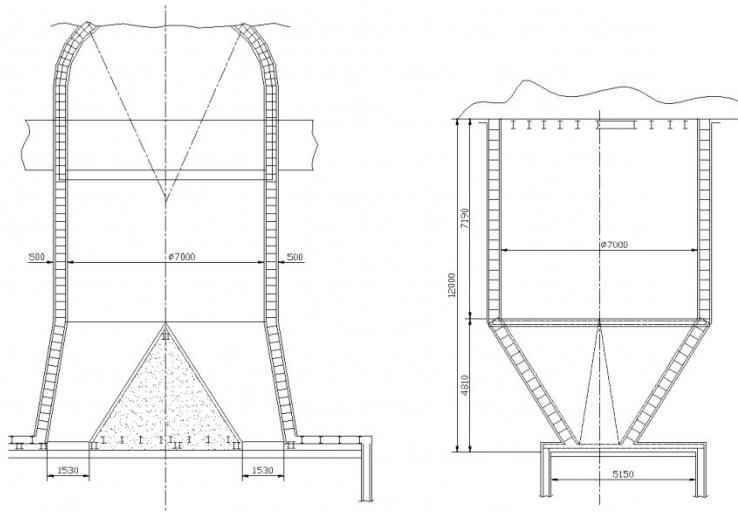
Вертикальный бункер круглого сечения с двумя выпускными отверстиями
